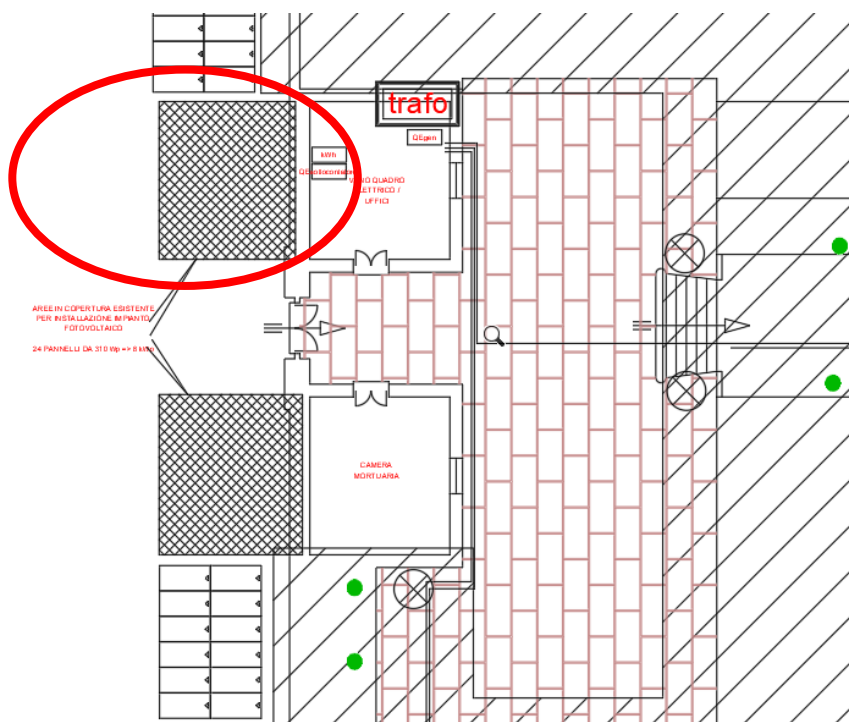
Schema planimetrico con indicazione delle coperture su cui installare i moduli fotovoltaici.
